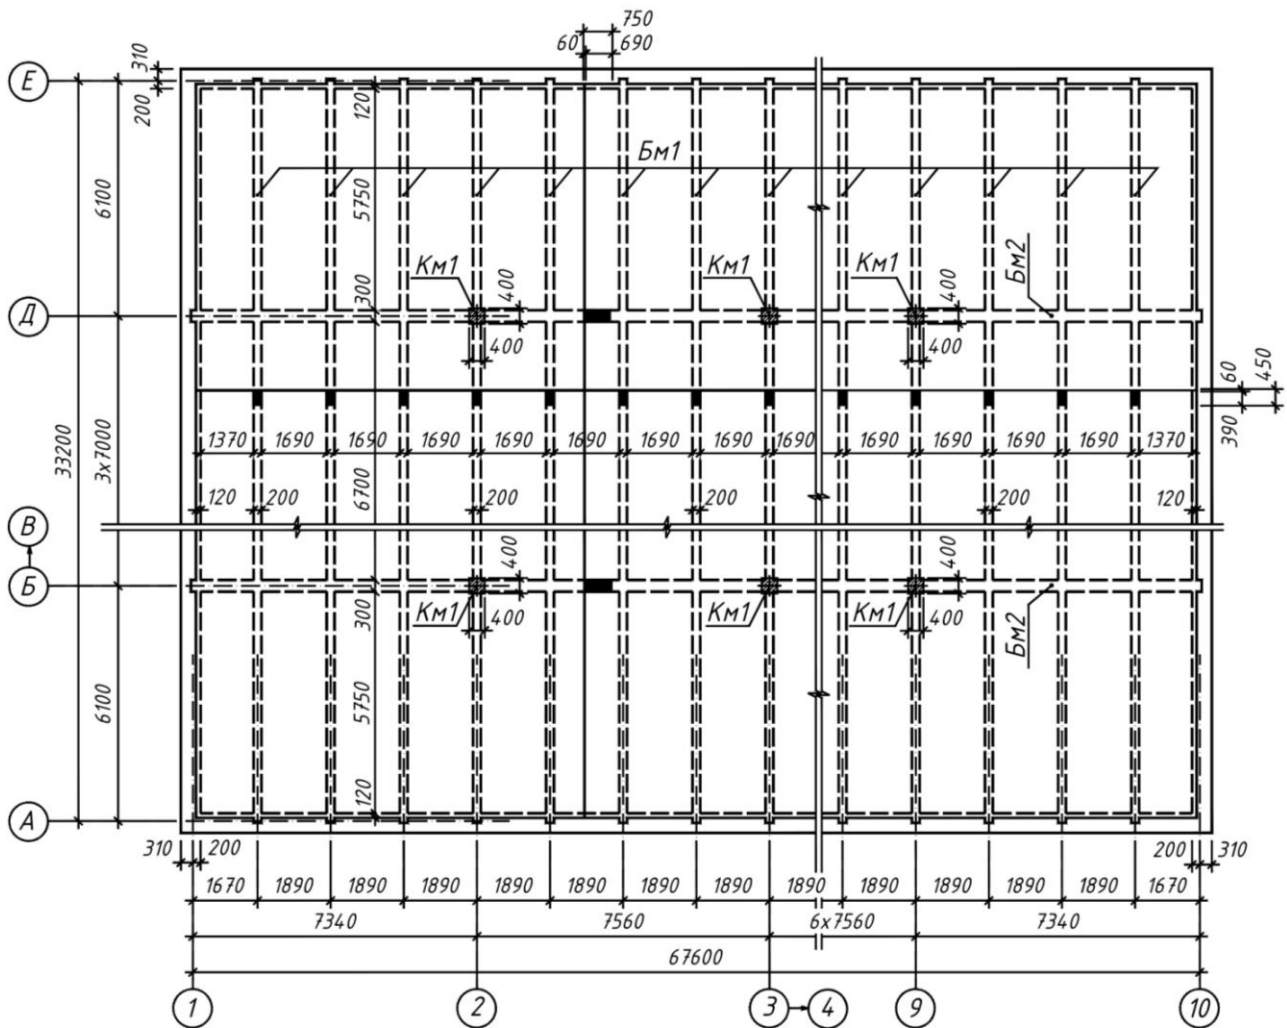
План перекриття над підземним паркінгом торгівельно-розважального центру
